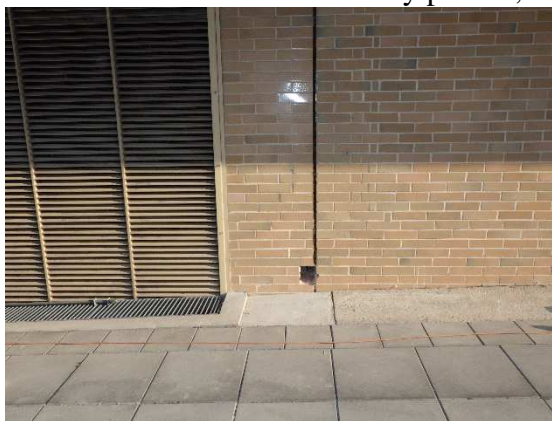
;14--sonda NS-A6 --přiblížení, detail obnažené části;
